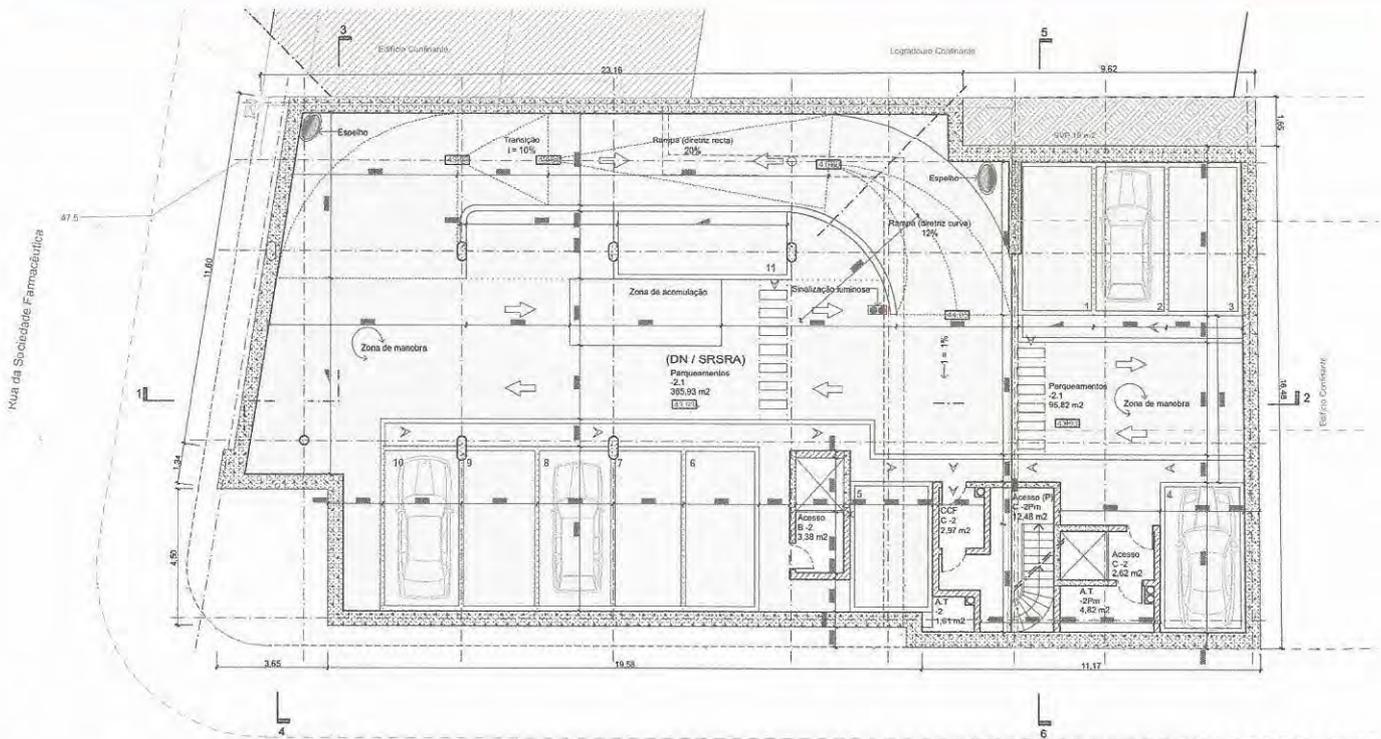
Planta da 2ª Cave de estacionamento – Dimensionamento da dotação de estacionamento
